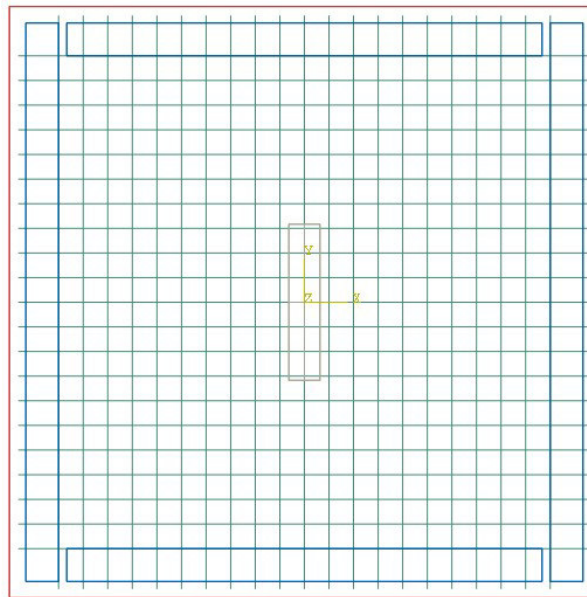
Chapa metálica nas lajes L1, L2 e L3.
